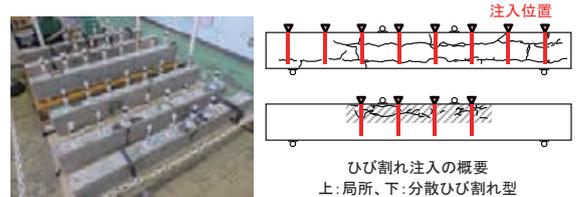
模擬損傷梁のひび割れ注入補修状況
